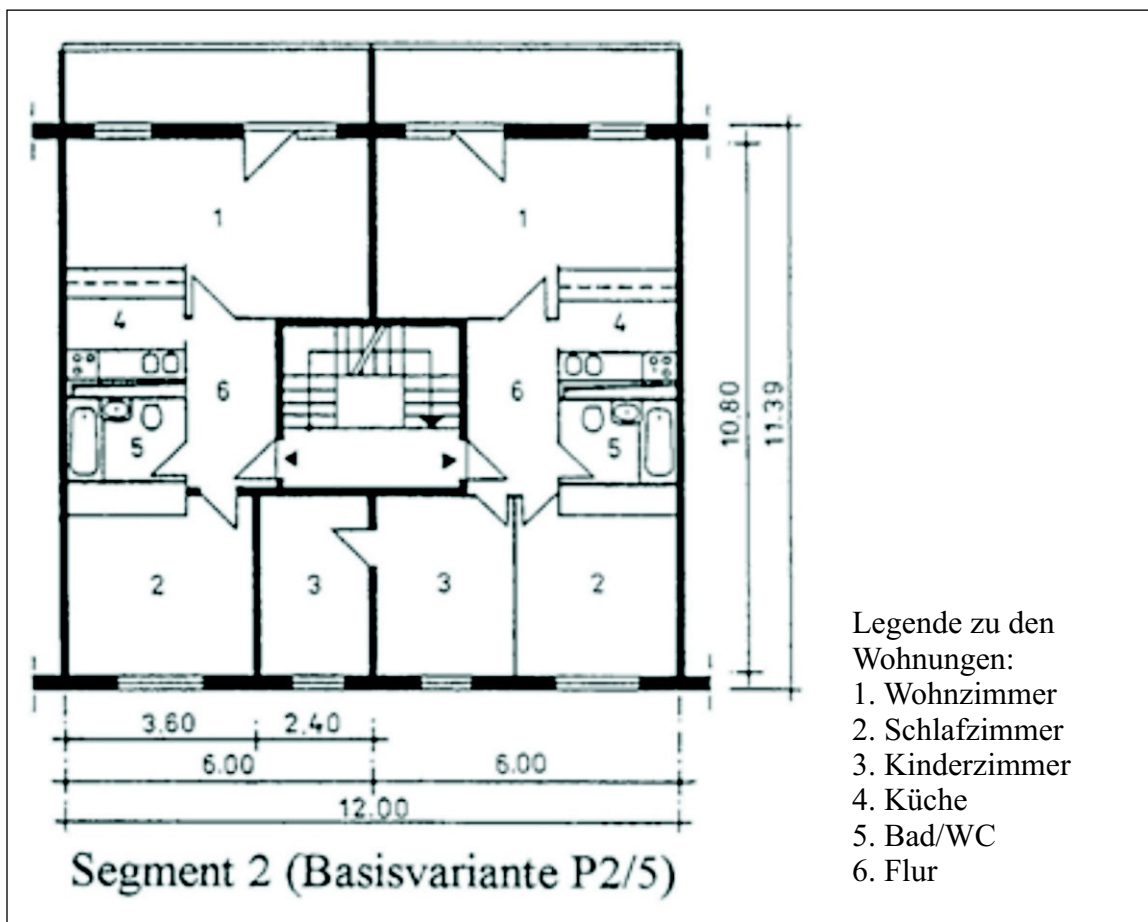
Abb. LVII Typ IW 67 (zu Typenserie P2, Grundriss Segment 2 Basisvariante P2/5)
